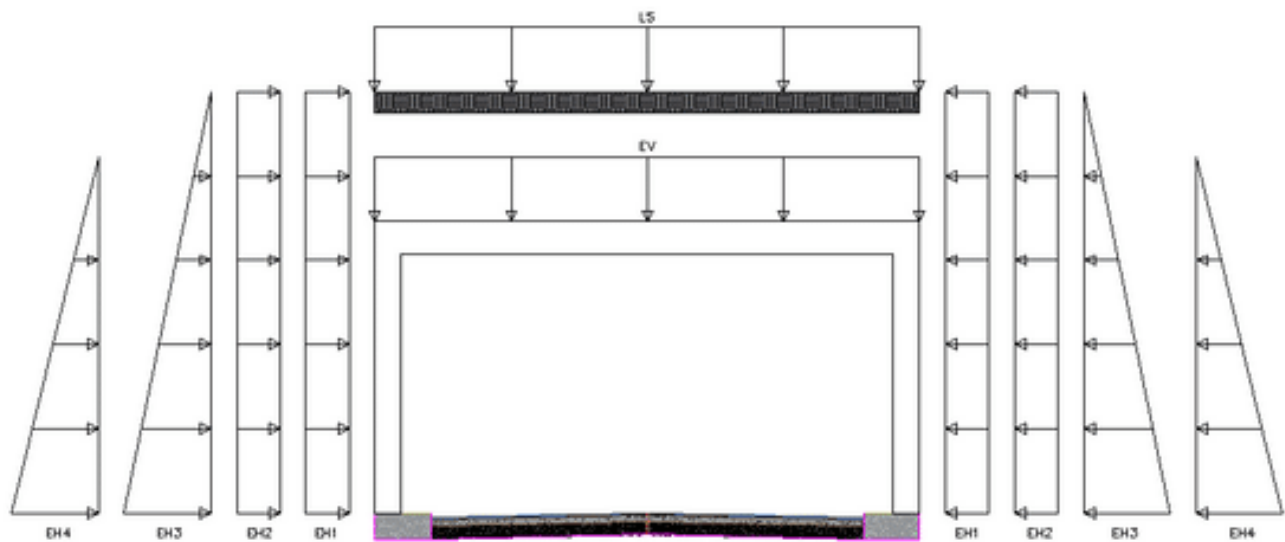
Cargas aplicadas a la estructura del túnel
